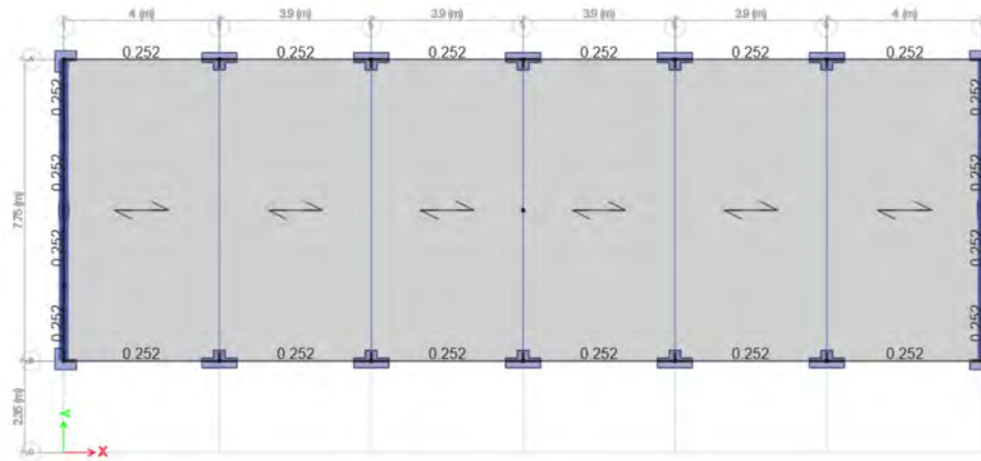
Carga distribuida en las vigas debido a la tabiquería (Techo 3/ETABS)
